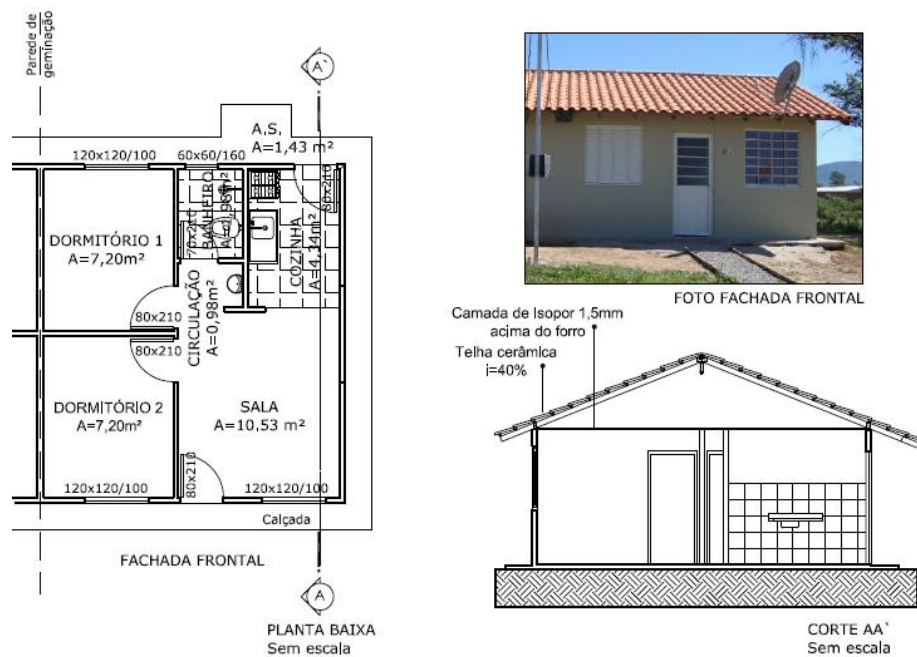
Planta baixa, corte e foto da fachada frontal da habitação-tipo do Residencial Zilda Arns
